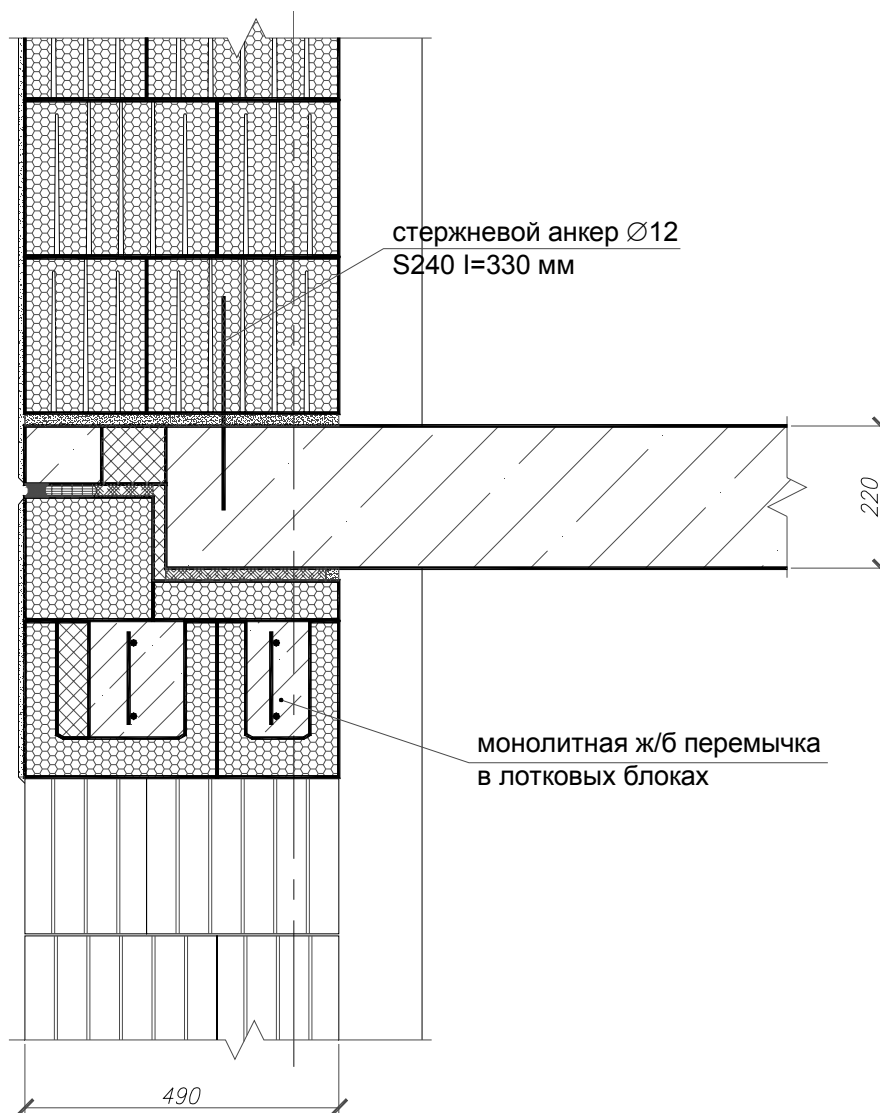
Узел примыкание стены из керамзитобетонных камней к перекрытию на участке с проемом
